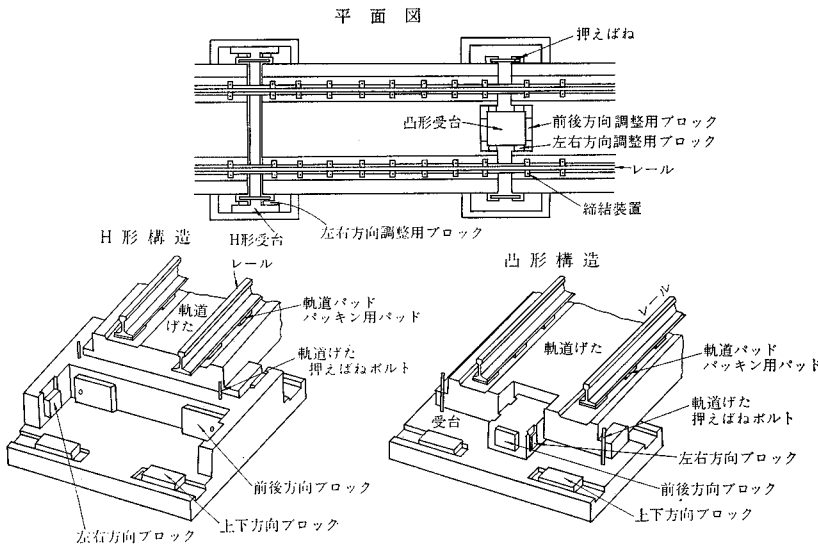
スラブリ軌道 M (コンクリートスラブリ式マット調節形)
